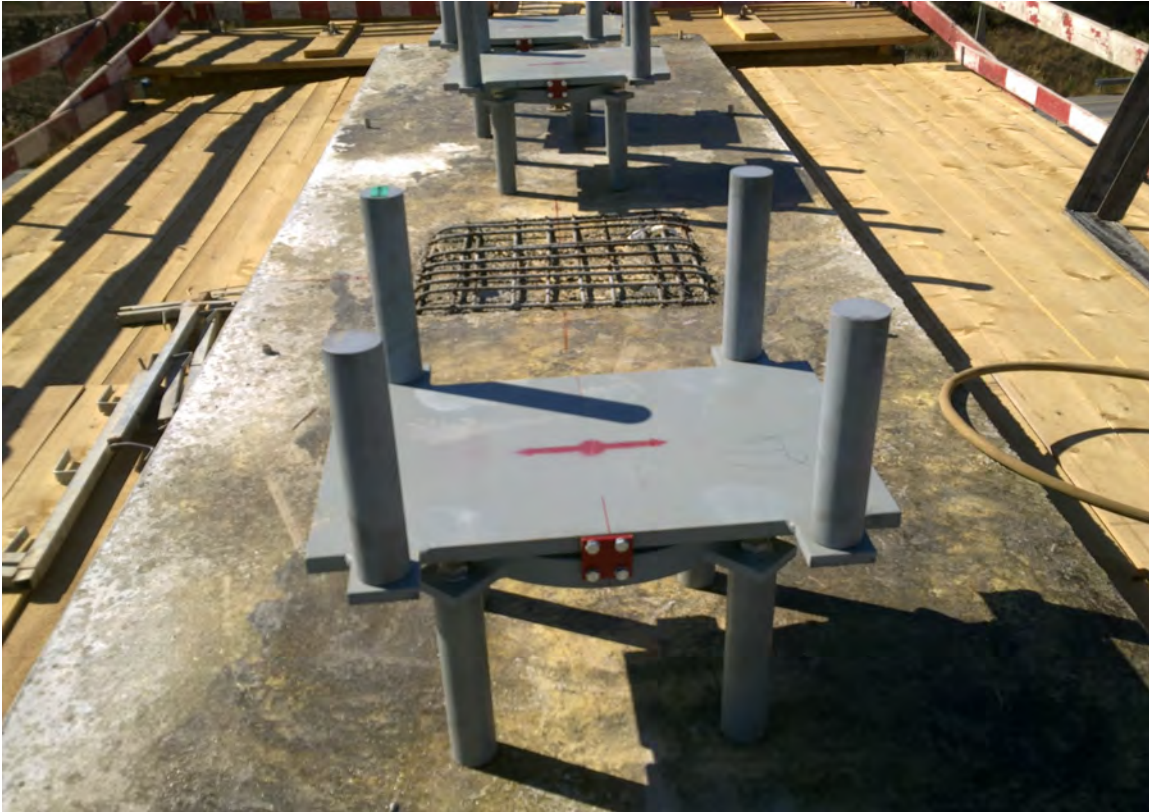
Colocação de aparelhos de apoio no capitel da Ponte sobre o Rio Azibo
